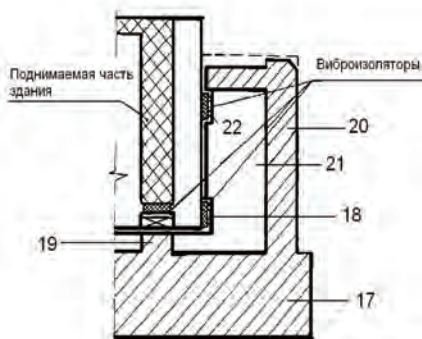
Схема виброизоляции цокольного этажа в основании здания.
